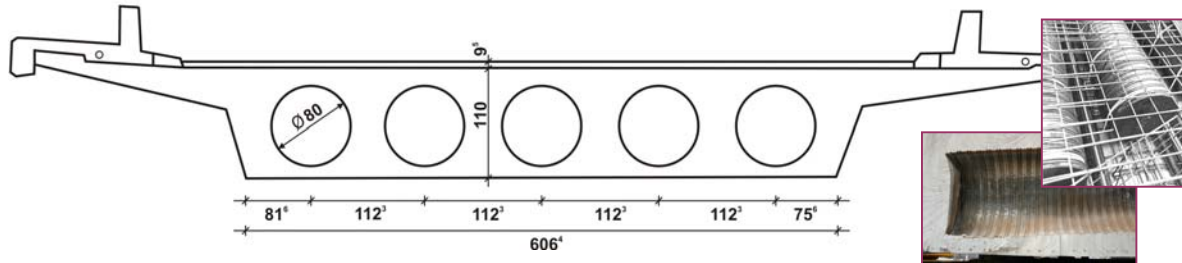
Brückenaufbau: Mitte: Querschnitt, rechts: Hohlkörper, beim Einbau und als Sägeschnitt beim Rückbau der Brücke (Maße in cm)
